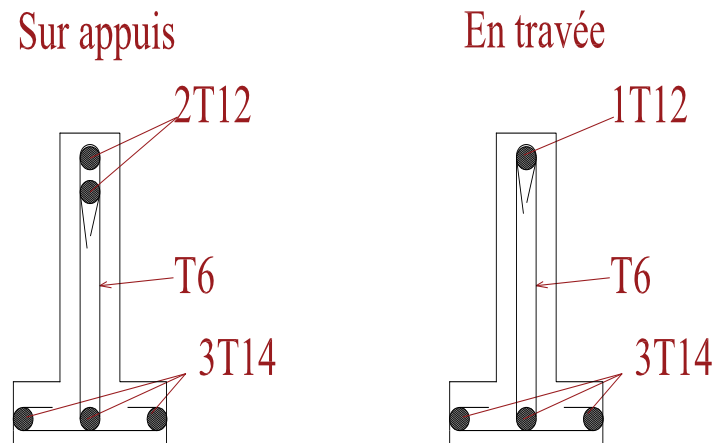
Schéma de ferrailage du poutrelle RDC et étage courant.
